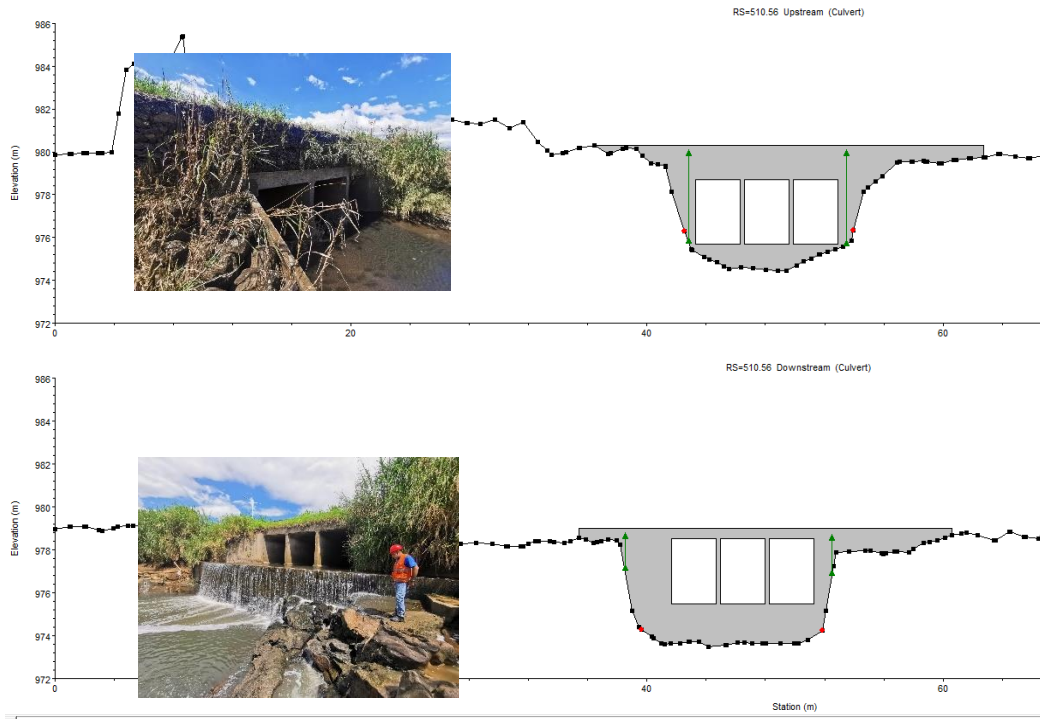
Corte transversal de las alcantarillas actuales, entrada y la salida de la estructura.
